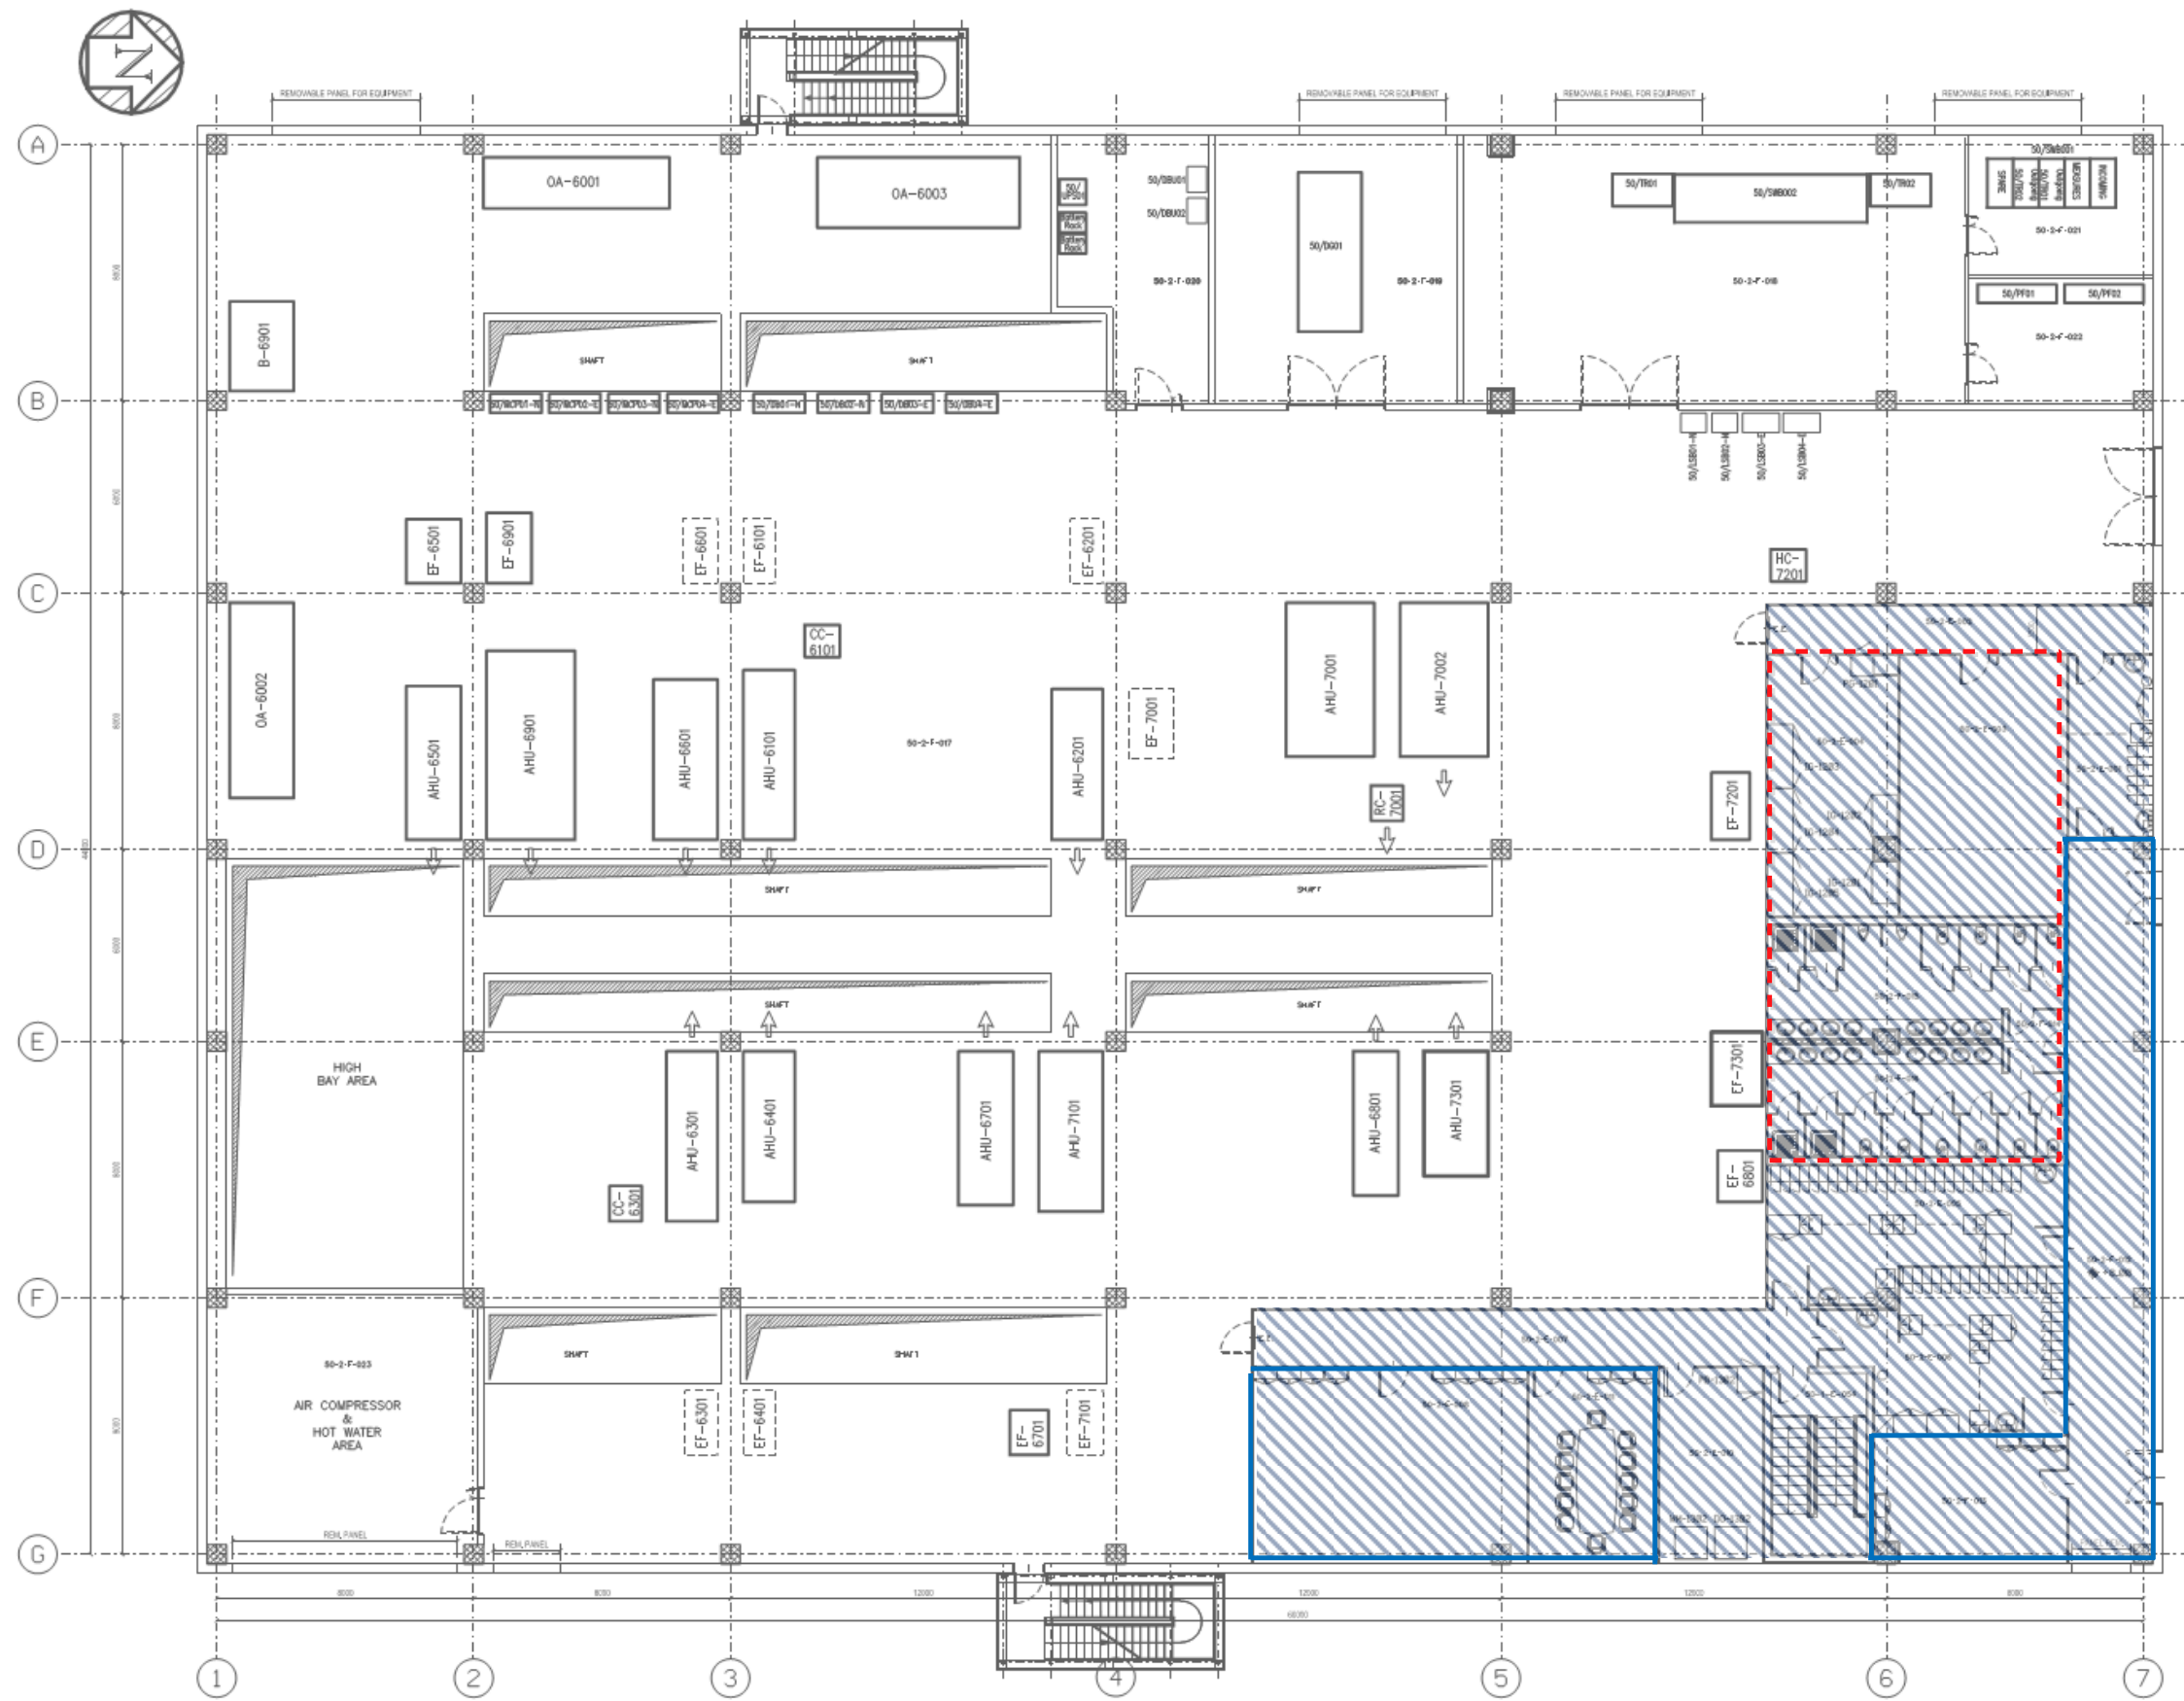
2 – Zoning: locali dell’impianto asserviti ai sistemi dell’impianto HVAC. Primo piano dell’edificio di produzione.
